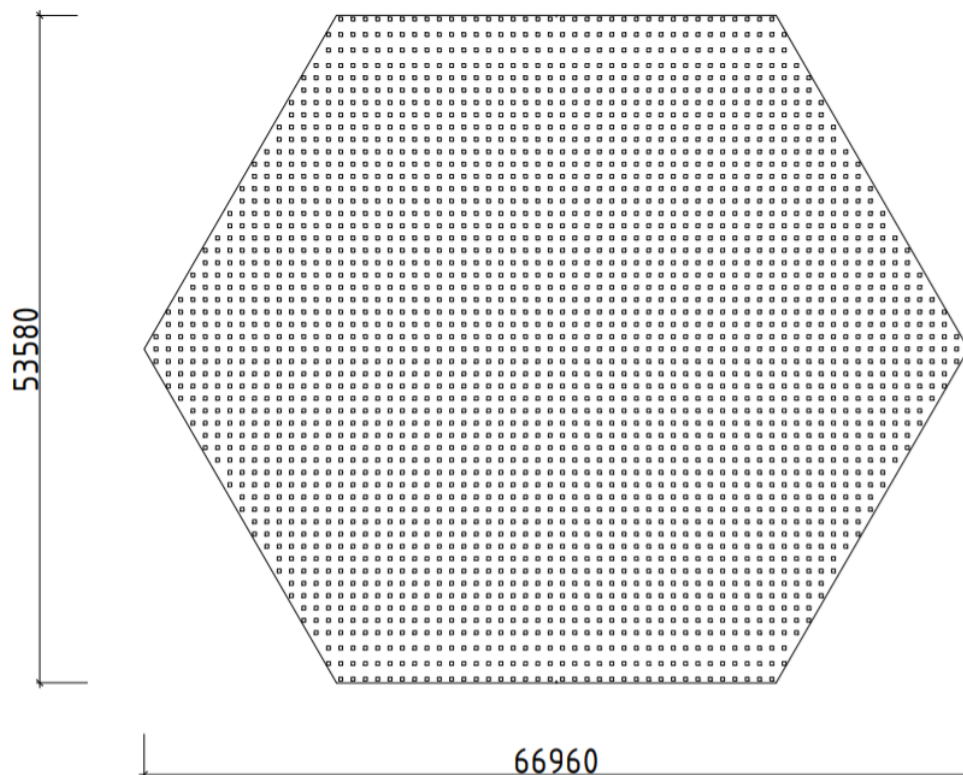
Опалубочный чертеж монолитной плиты фундамента
